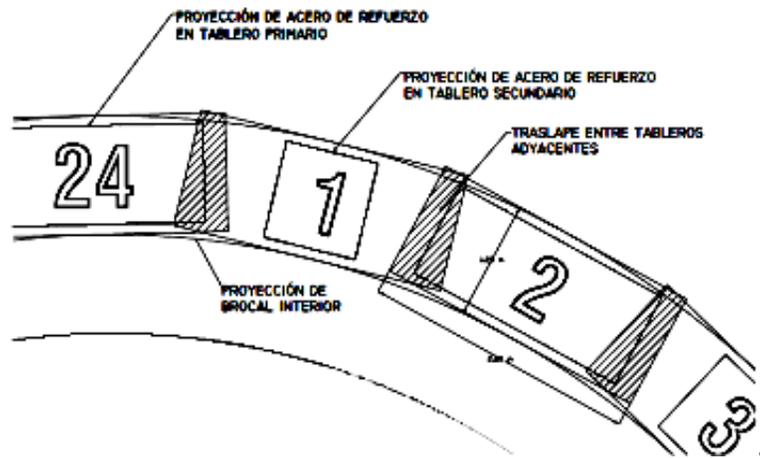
15 Imagen de traslape entre tableros tipo A1 y A2
